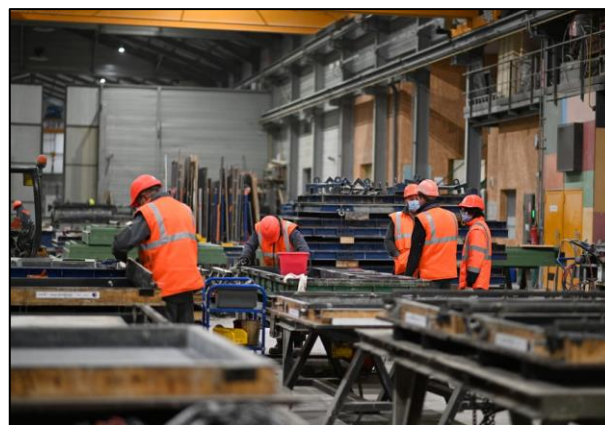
Atelier foraine (source : site <https://www.infociments.fr/le-renouveau-de-la-construction-hors-site> )
